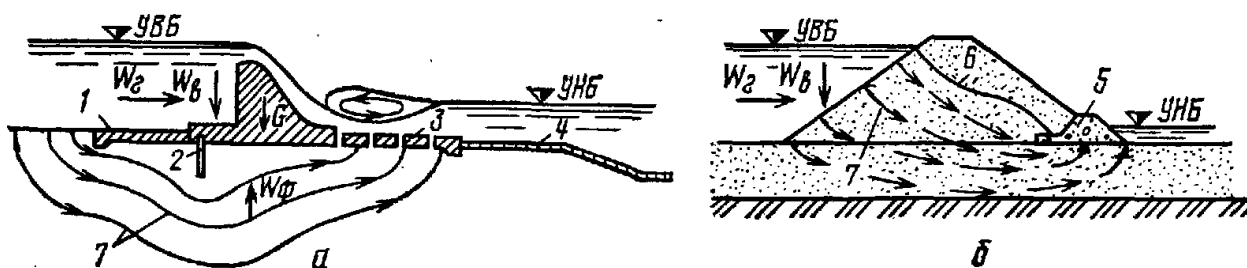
Схемы воздействия воды на бетонную (а) и грунтовую (б) плотины и их основания: 1 – понур, 2 – шпунт, 3 – водобой, 4 – рисберма, 5 – дренажная призма, 6 – депрессионная кривая, 7 – линии тока фильтрующей воды.
